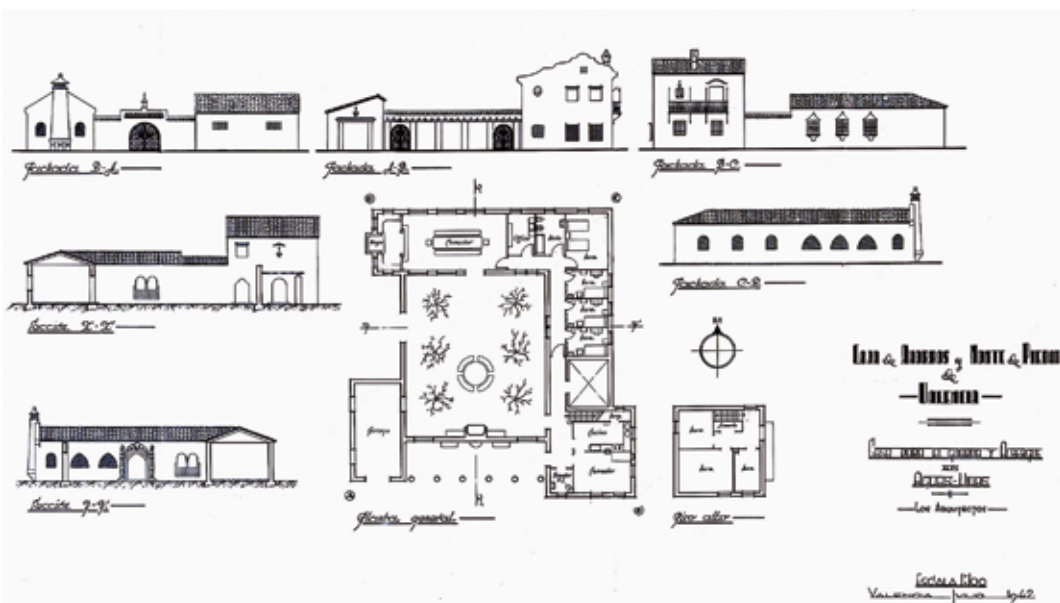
/ Planta y alzados Casa del Guarda, julio de 1942.
